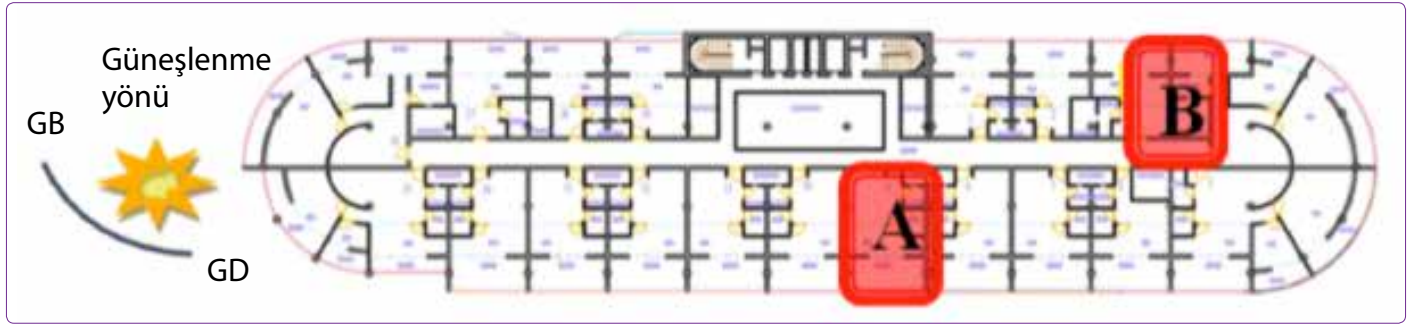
Ulusoy Plaza vaziyet planı.²¹
